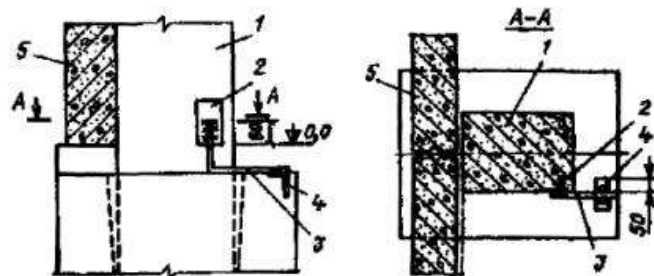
Схема соединения закладного изделия колонны и фундамента:
